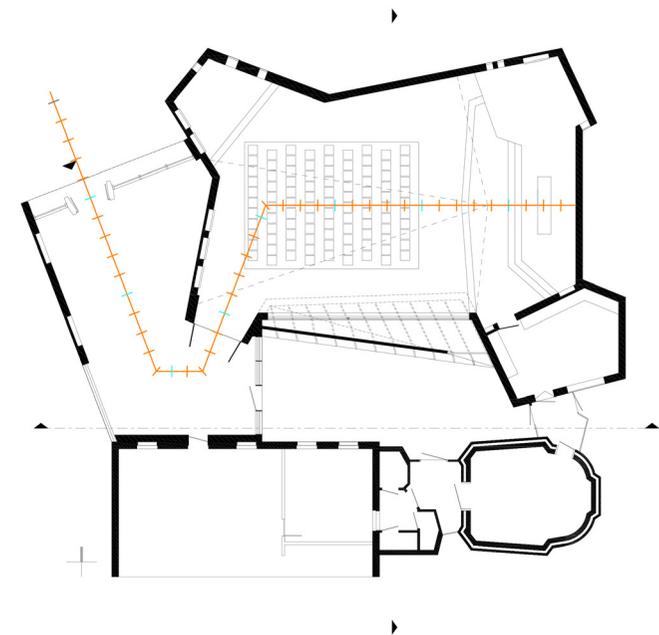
Grundriss mit Lichtmessungspunkten (o.M.)
